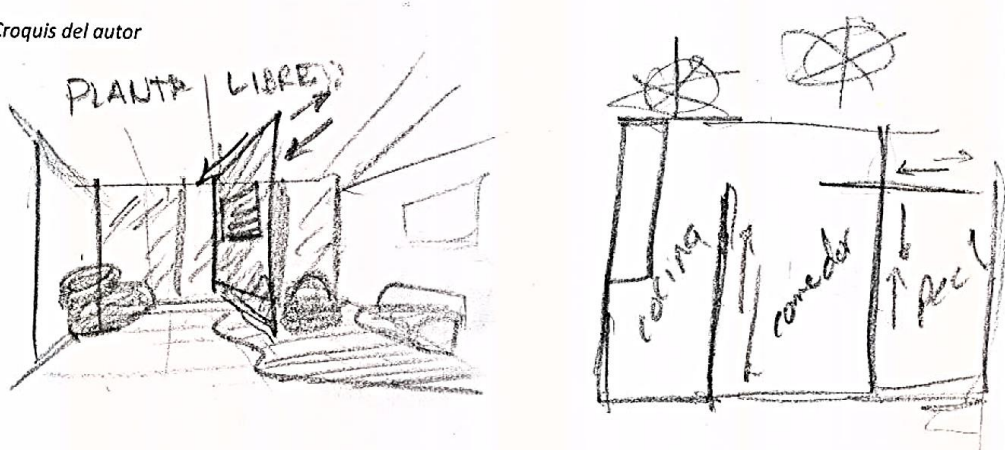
conceptos para la planta tipo, fuente: por el autor
